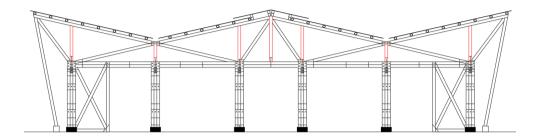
Secciones de Montantes de Sobrecubierta en Vista Transversal. Fuente: [Propia]
